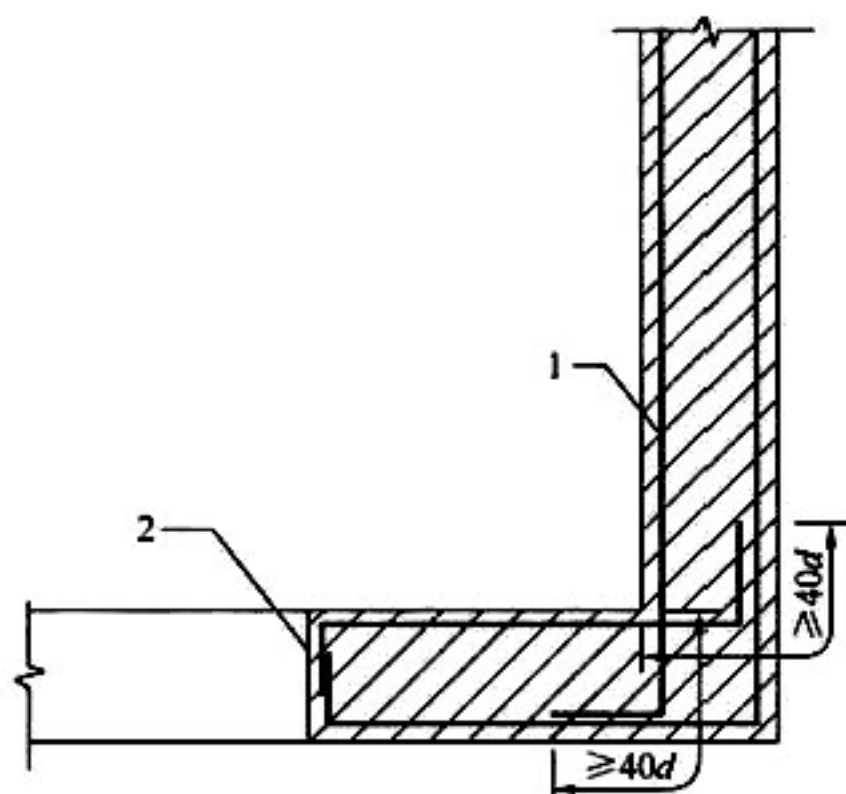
配筋砖圈梁交接处和转角处钢筋搭接
